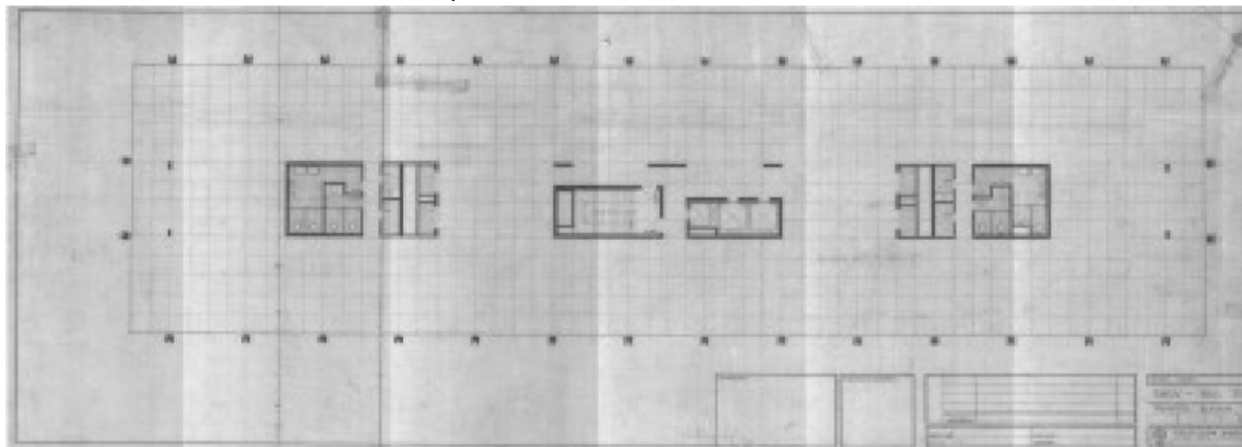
SMOV, Planta baixa pavimento tipo com a modulação 1,25m x 1,25m. Projeto original (1966)
